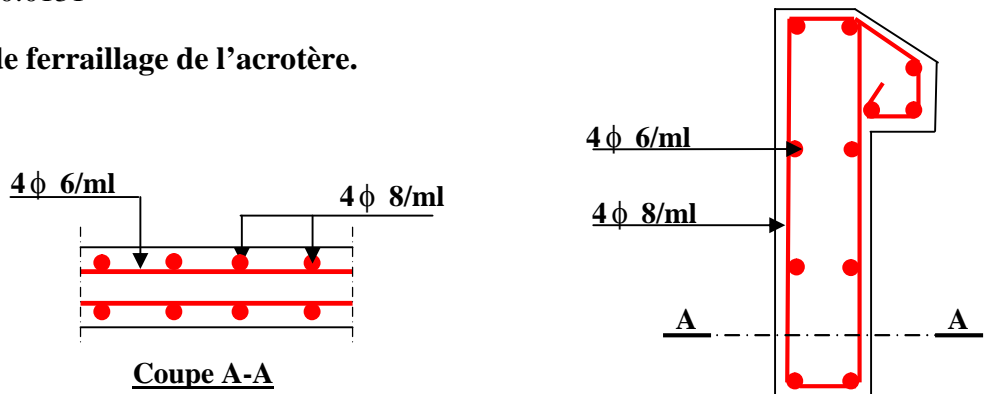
Schéma de ferrailage de l'acrotère (Terrasse inaccessible).
